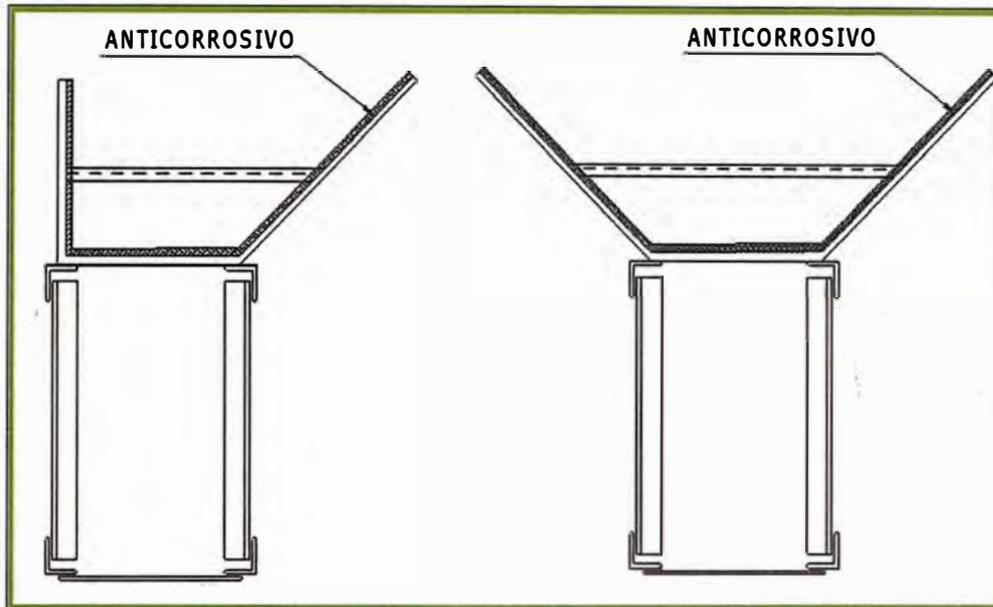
Lado izquierdo: Viga canal metálica forma simple. Lado derecho: Viga canal metálica central o doble (Referencia 3)
